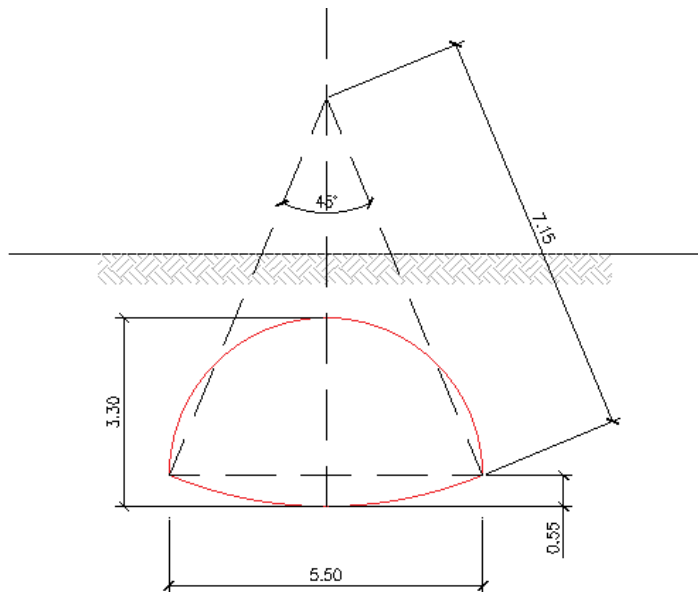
Arroyo White. Sección modelo N° 18.
